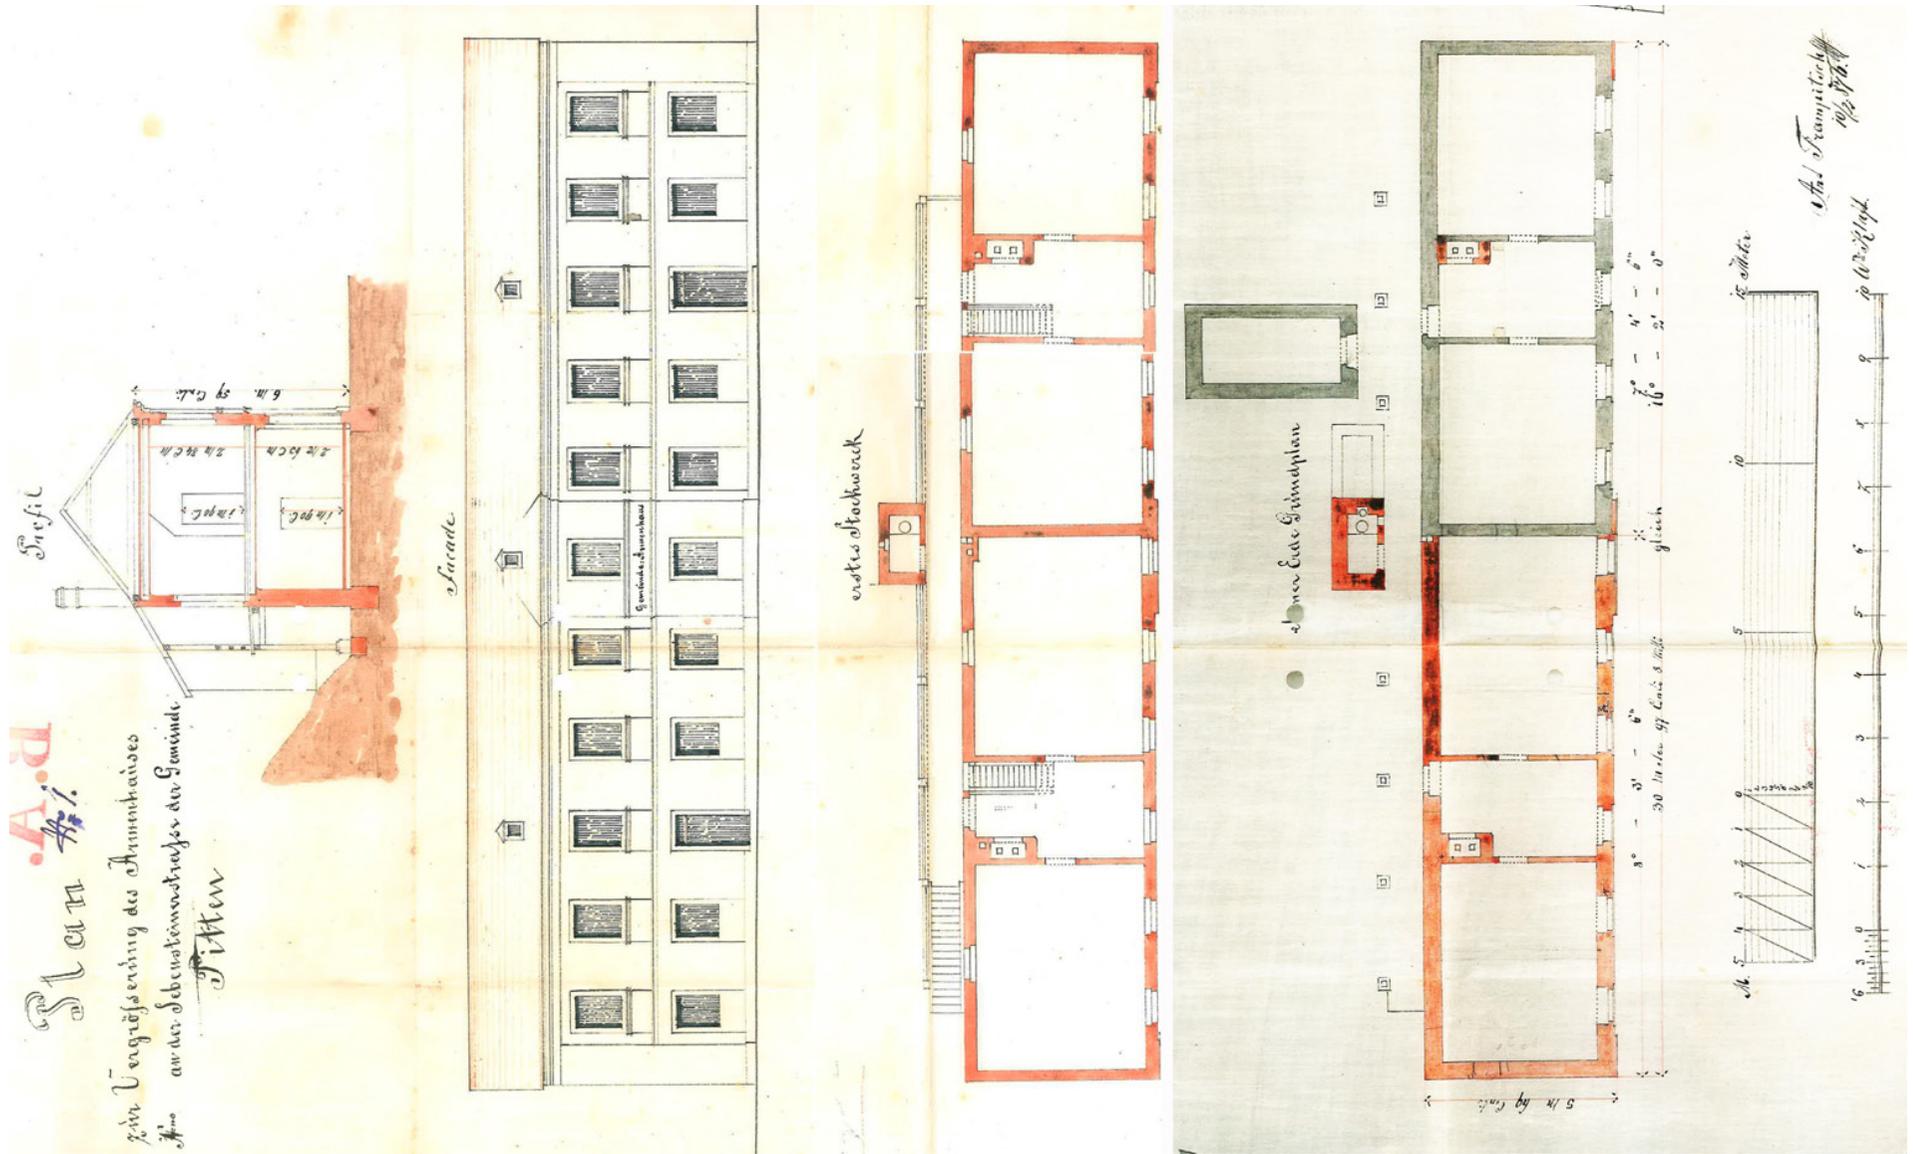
| Umbauplan von Anton Trampitsch zur Vergrößerung des Armenhauses 1876
